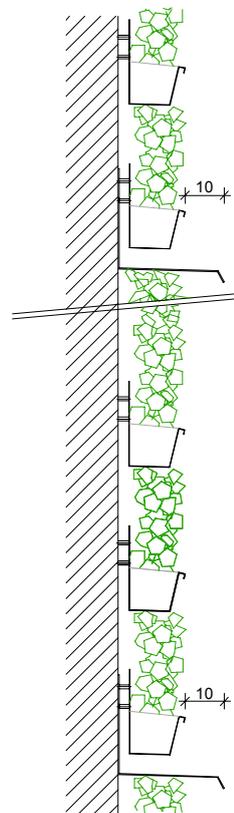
Teilflächige wandgebundene Vertikalbegrünung mit geschoßweiser Abschottung durch Stahlblechprofile © Stadt Wien
